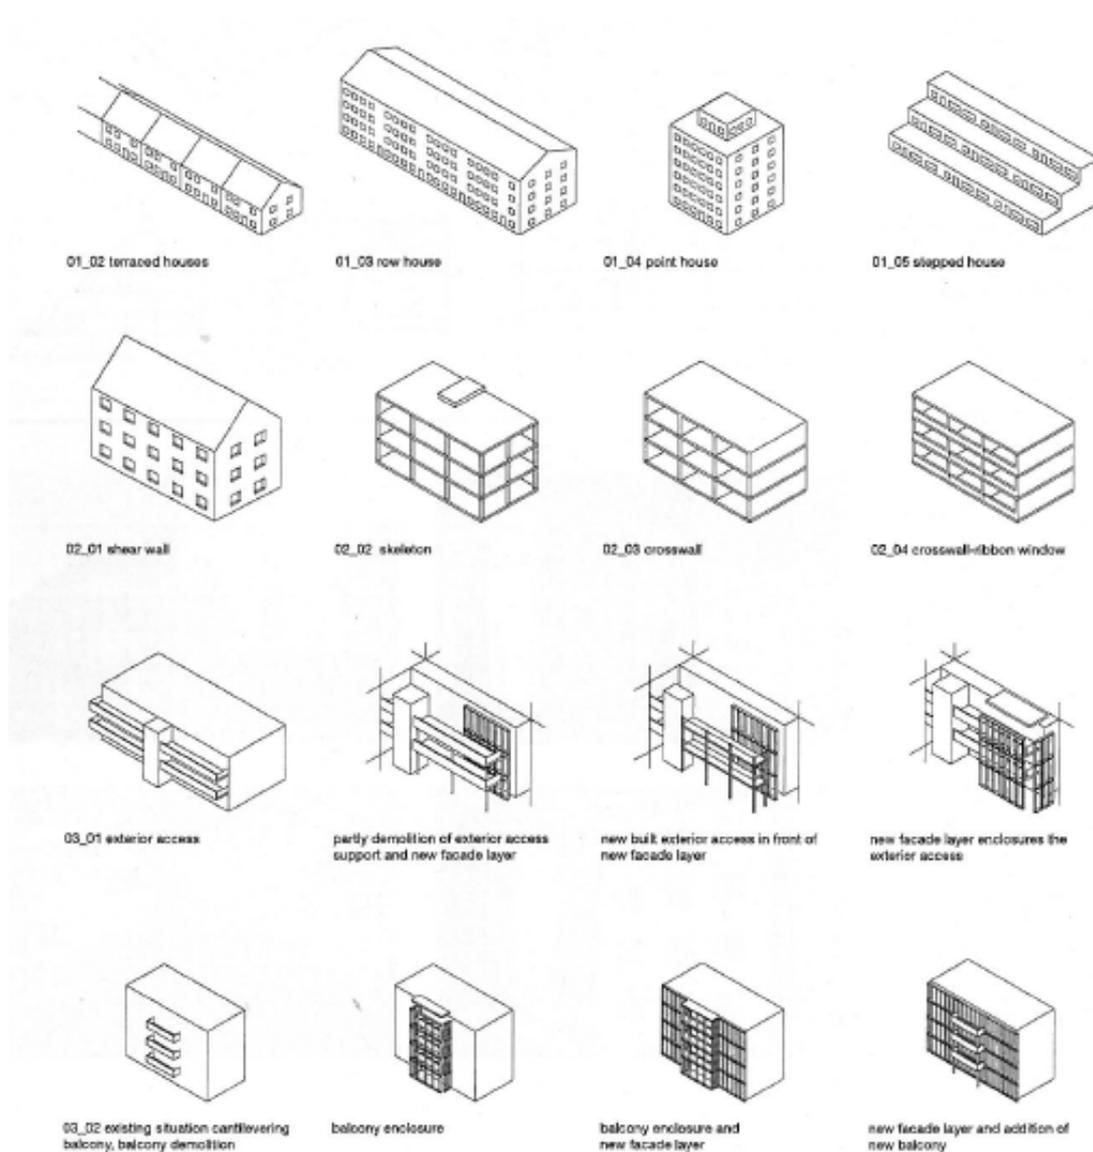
Geeignete Fassadentypen für vorgefertigte Fassadenelemente und Planungsansätze für Balkone; Quelle: Endbericht Projekt „TES EnergyFacade“, 2011, Woodwisdom Net
